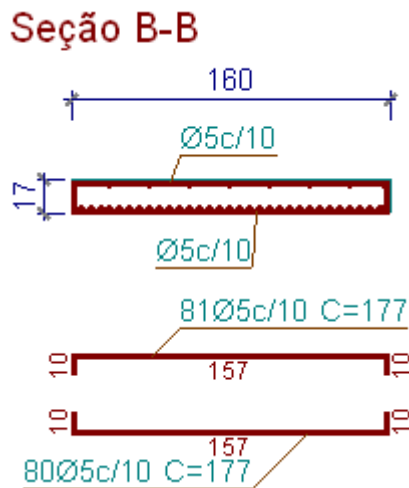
Corte BB: Detalhamento das armaduras transversais (Fonte: CYPECAD).
